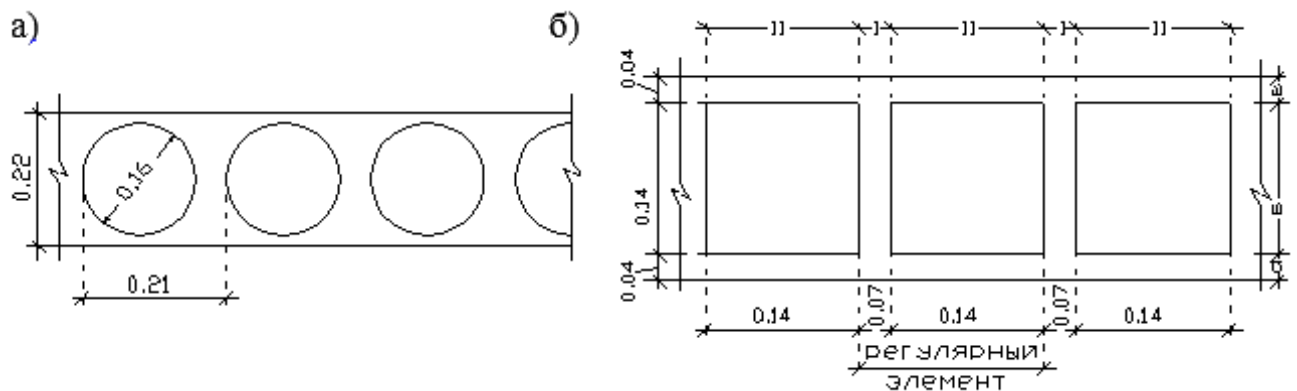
К расчету пустотной плиты перекрытия: а) разрез по фрагменту плиты; б) расчетная схема плиты с выделенным регулярным элементом
